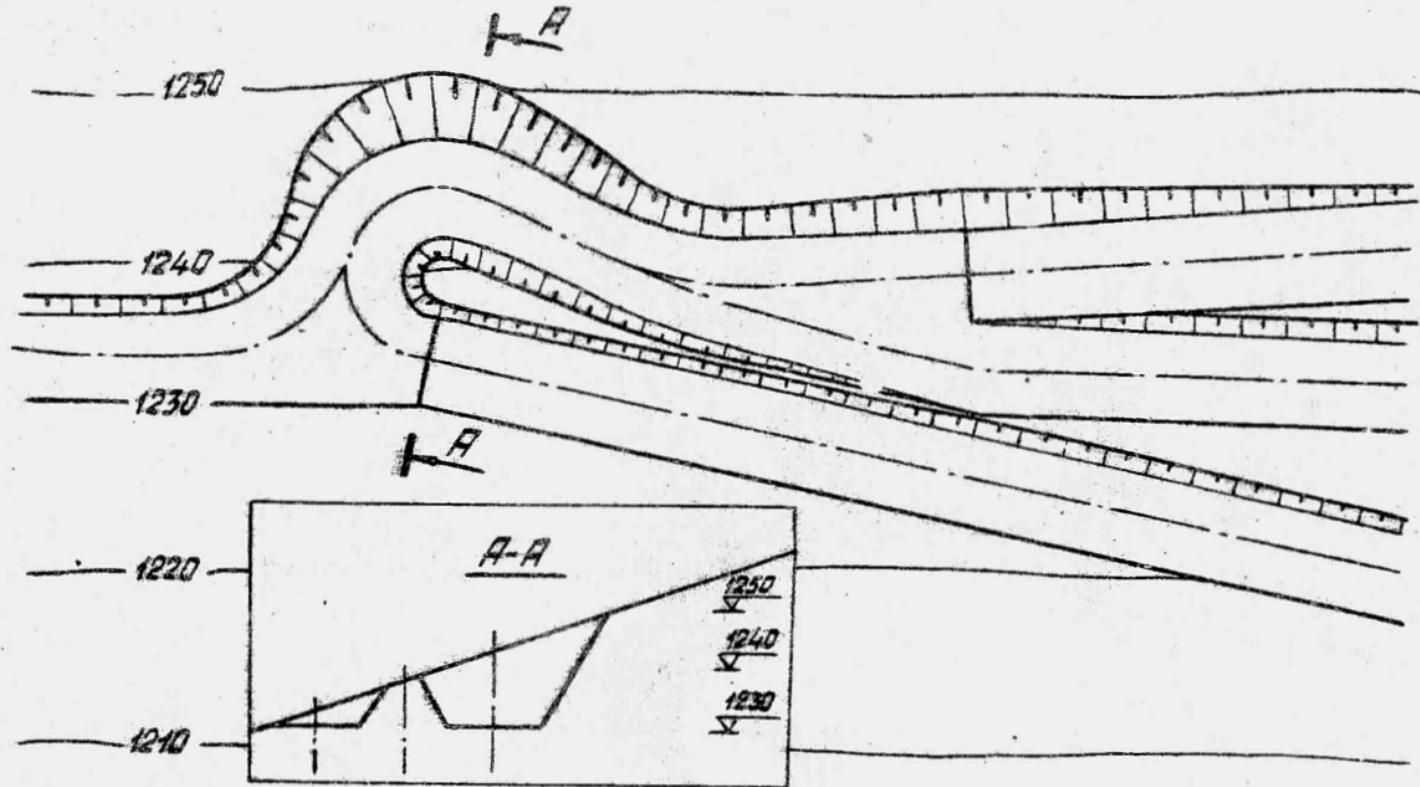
Двухстороннее примыкание соединительных грунтовых путей к въездной на площадке
